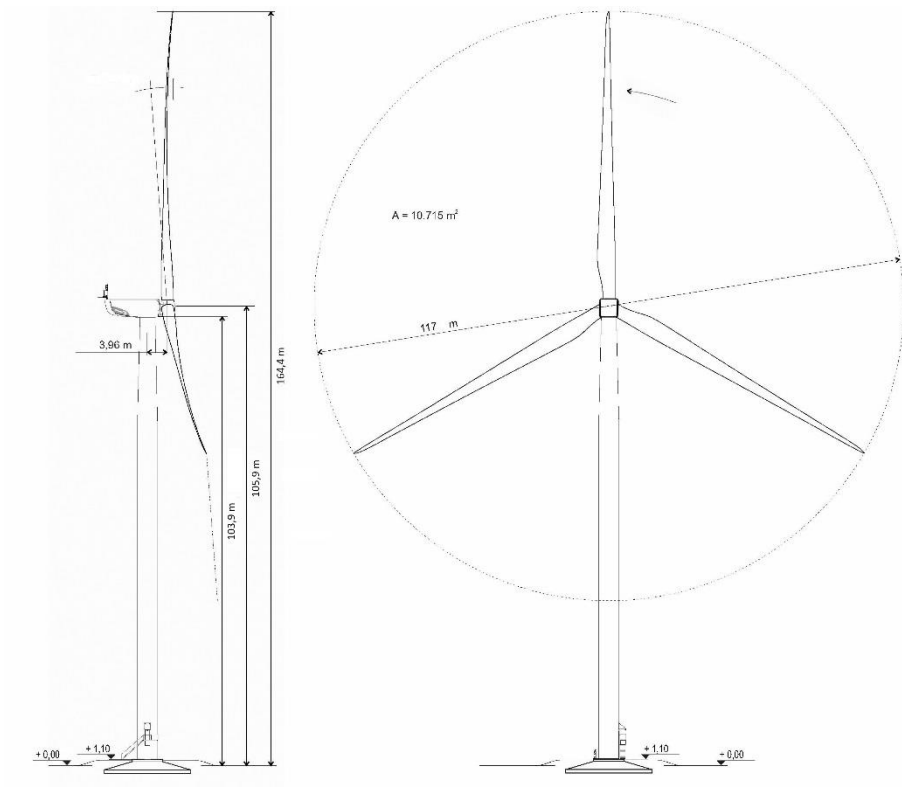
Plans en coupe de l'éolienne N117 – 3,6MW – 164 m
